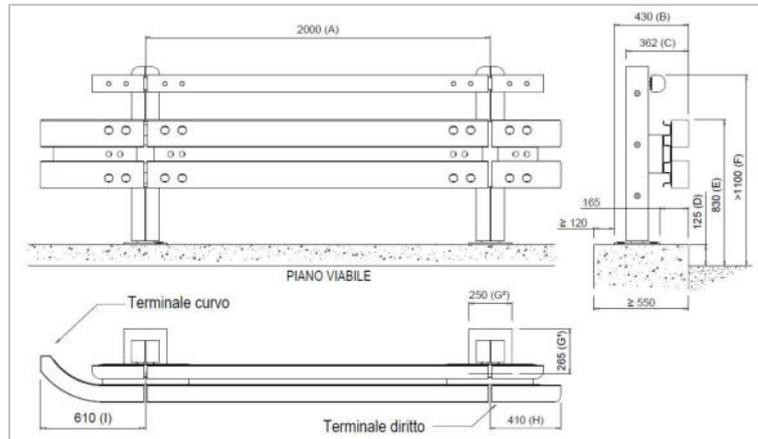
Pianta, prospetto e sezione tipo della barriera H1 BL in legno e Corten
